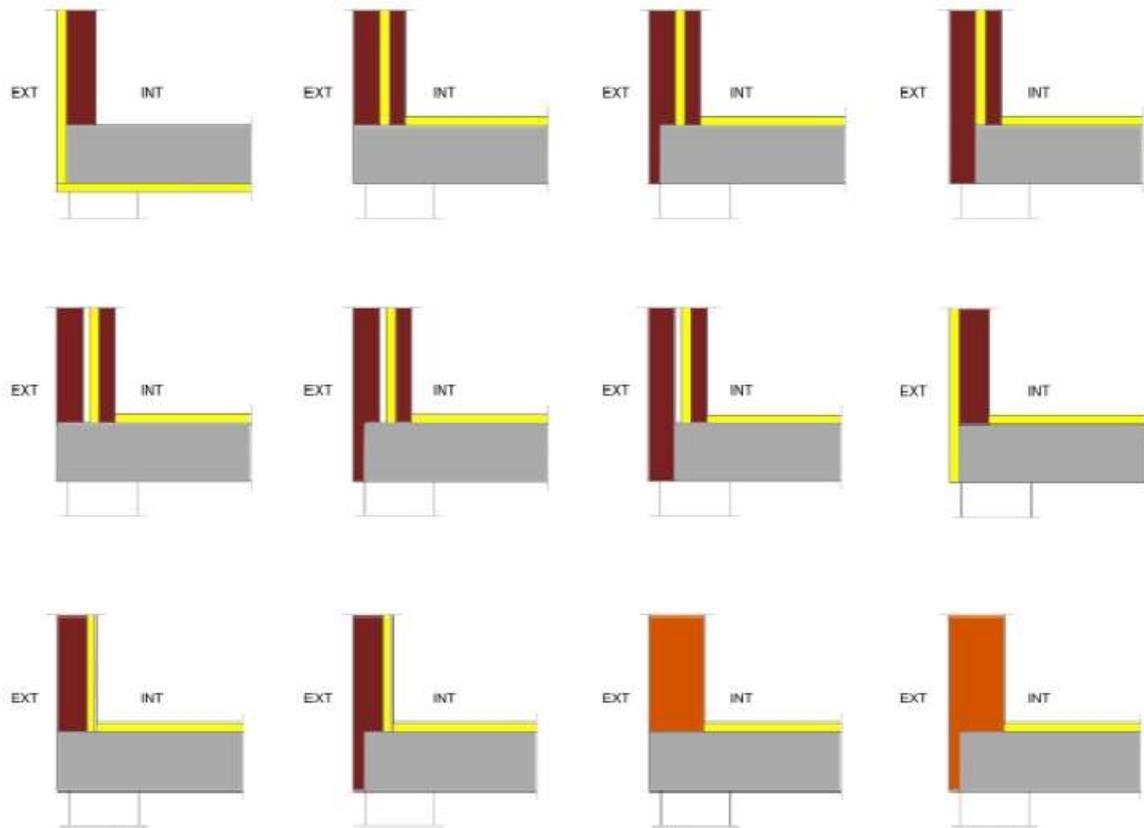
Aislamiento continuo entre la fachada y la losa en contacto con el exterior.
